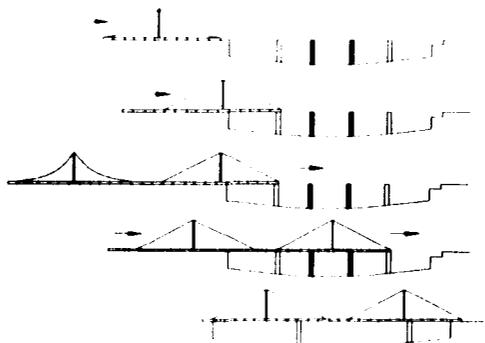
Procedimiento de erección del puente Jülischer Street en Dusseldrf, Alemania
